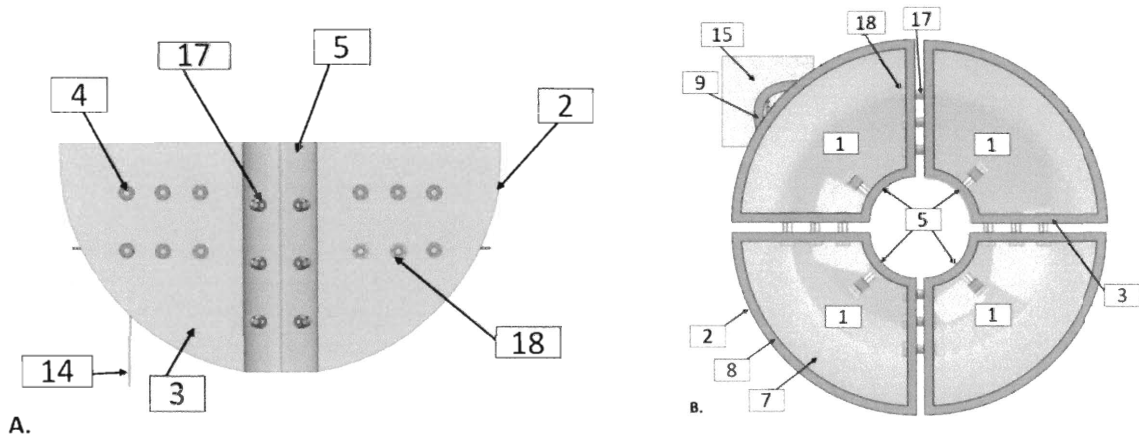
Elemente constructive ale ecofundației: A) Secțiune transversală a semisferei tip cochilă; B) Mod de asamblare a elementelor constructive
